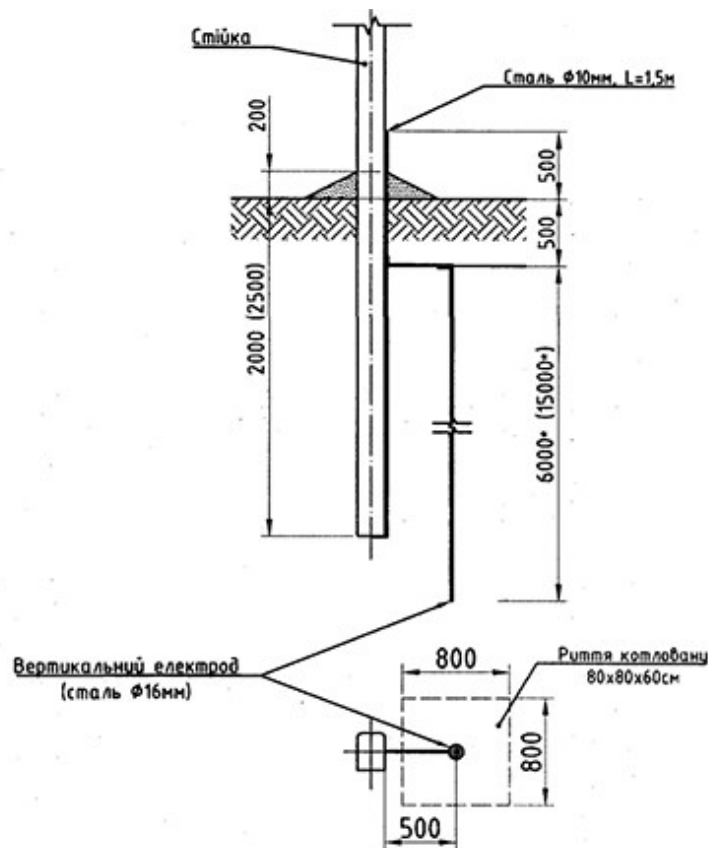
Штучний заземлюючий пристрій для опори без обладнання
